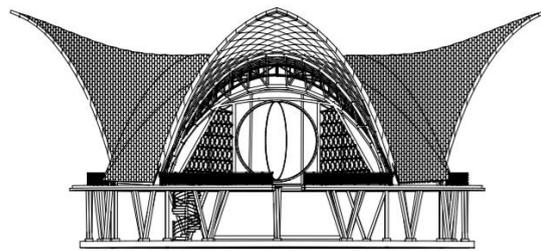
Tampak Depan dan Belakang Gedung B
